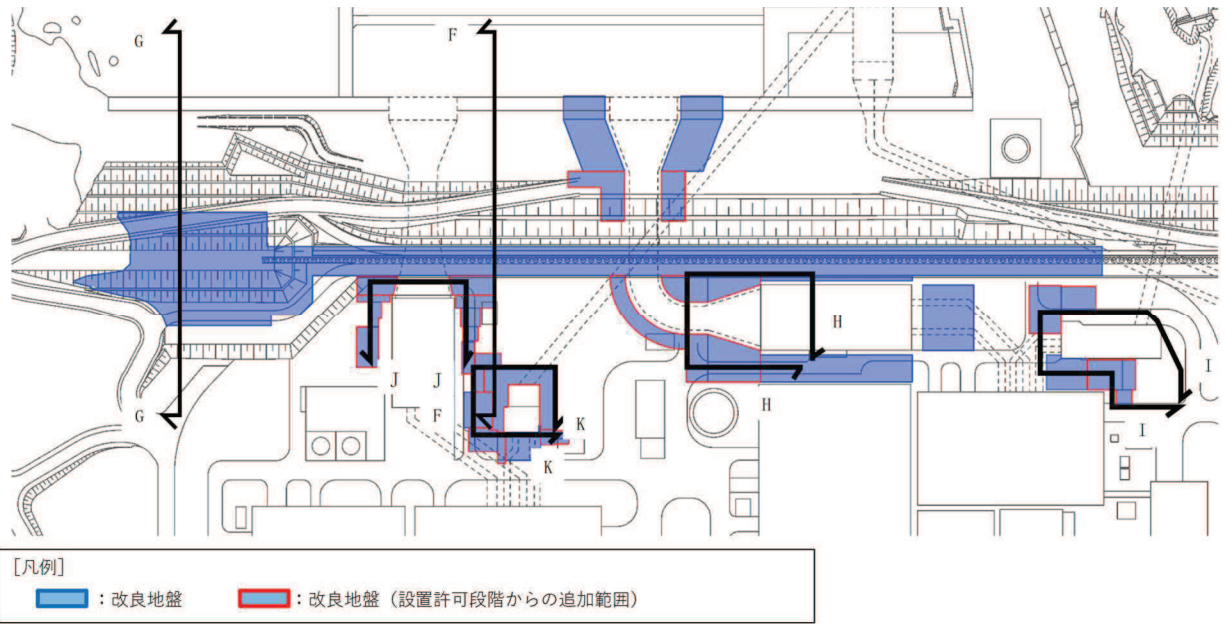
地盤改良体の平面配置図 (防潮堤, 防潮壁, 防潮堤 (第 3 号機取水路横断面))
